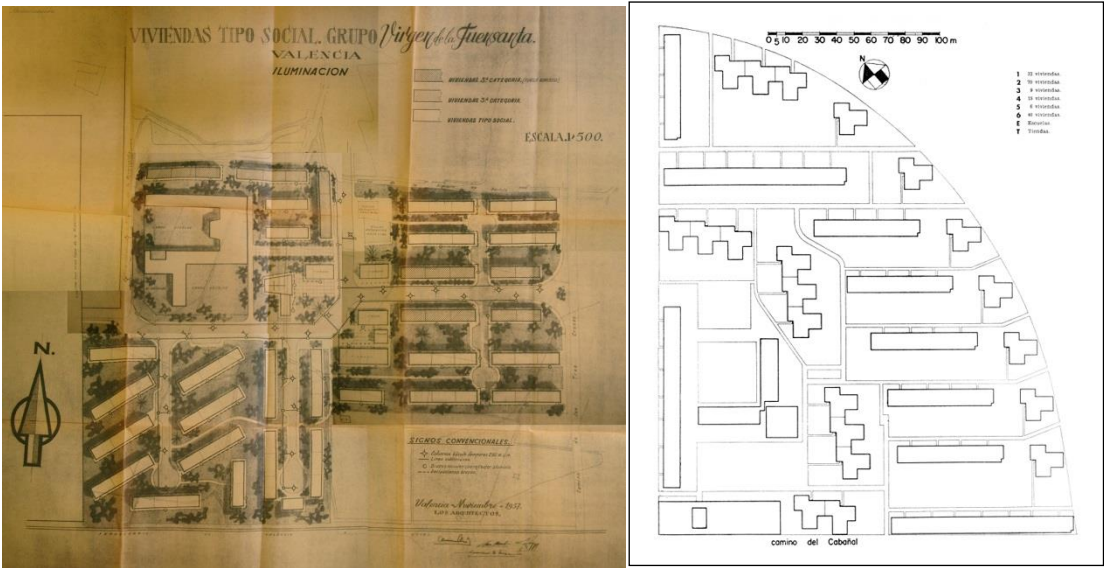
Izquierda: Grupo Virgen de la Fuensanta. Planta general del Proyecto de Urbanización, 1957 (Archivo Histórico municipal, Valencia). Derecha: Grupo Virgen del Carmen. Planta de conjunto (Informes de la Construcción, 149, 1963).
